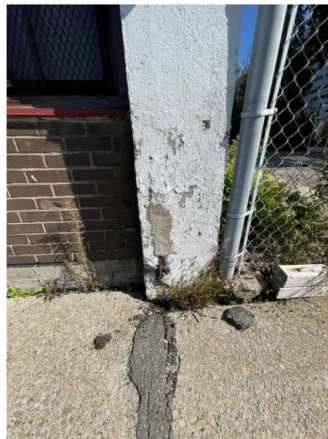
Détail d'une colonne en béton présentant un éclat et une armature visible à la base
